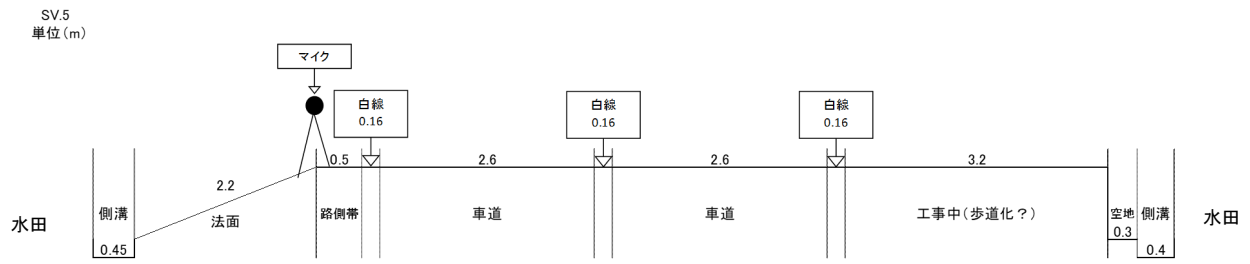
(3) 道路構造断面図 (SV.5)
